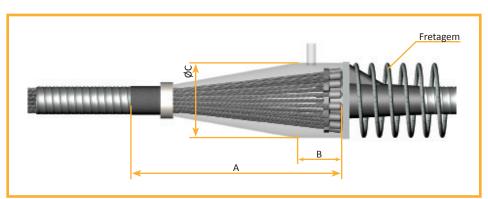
Ancoragem de emenda Rudloff tipo "K" (SEÇÃO TRANSVERSAL)
